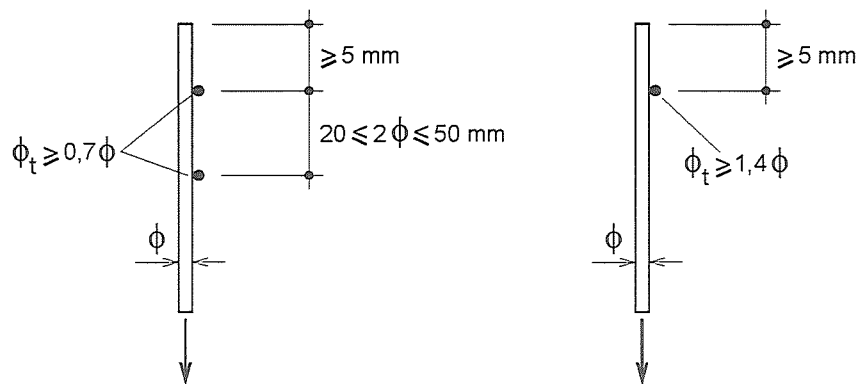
Ancoragem de armadura transversal por meio de barras soldadas
